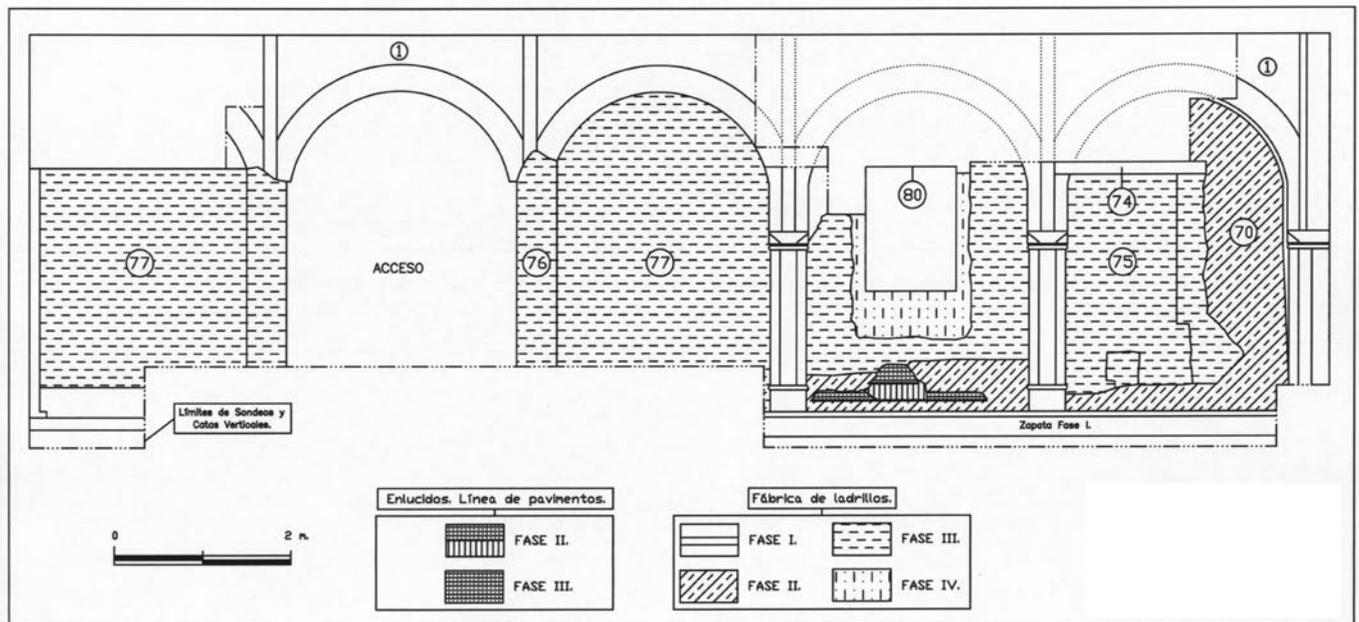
Paramento fachada sur (nº 1). Planta baja. Alzado interior. Análisis estratigráfico con diferenciación de fases constructivas.
